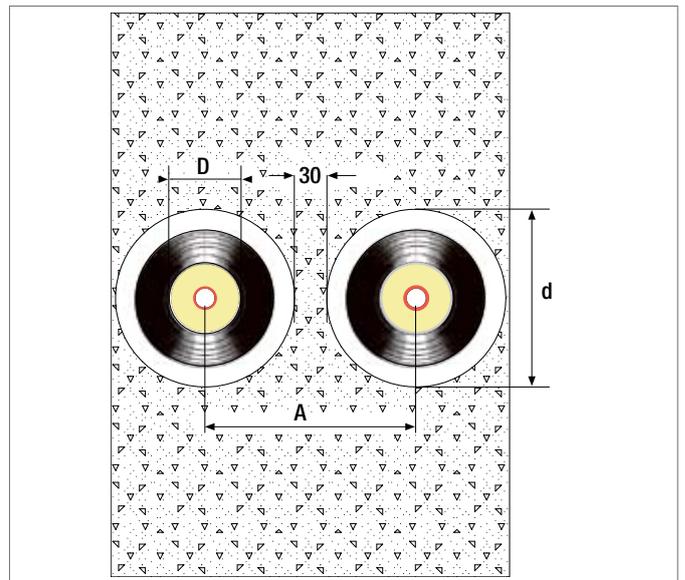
, Joint d'étanchéité mural dentelé - Vue de face, trou carroté
